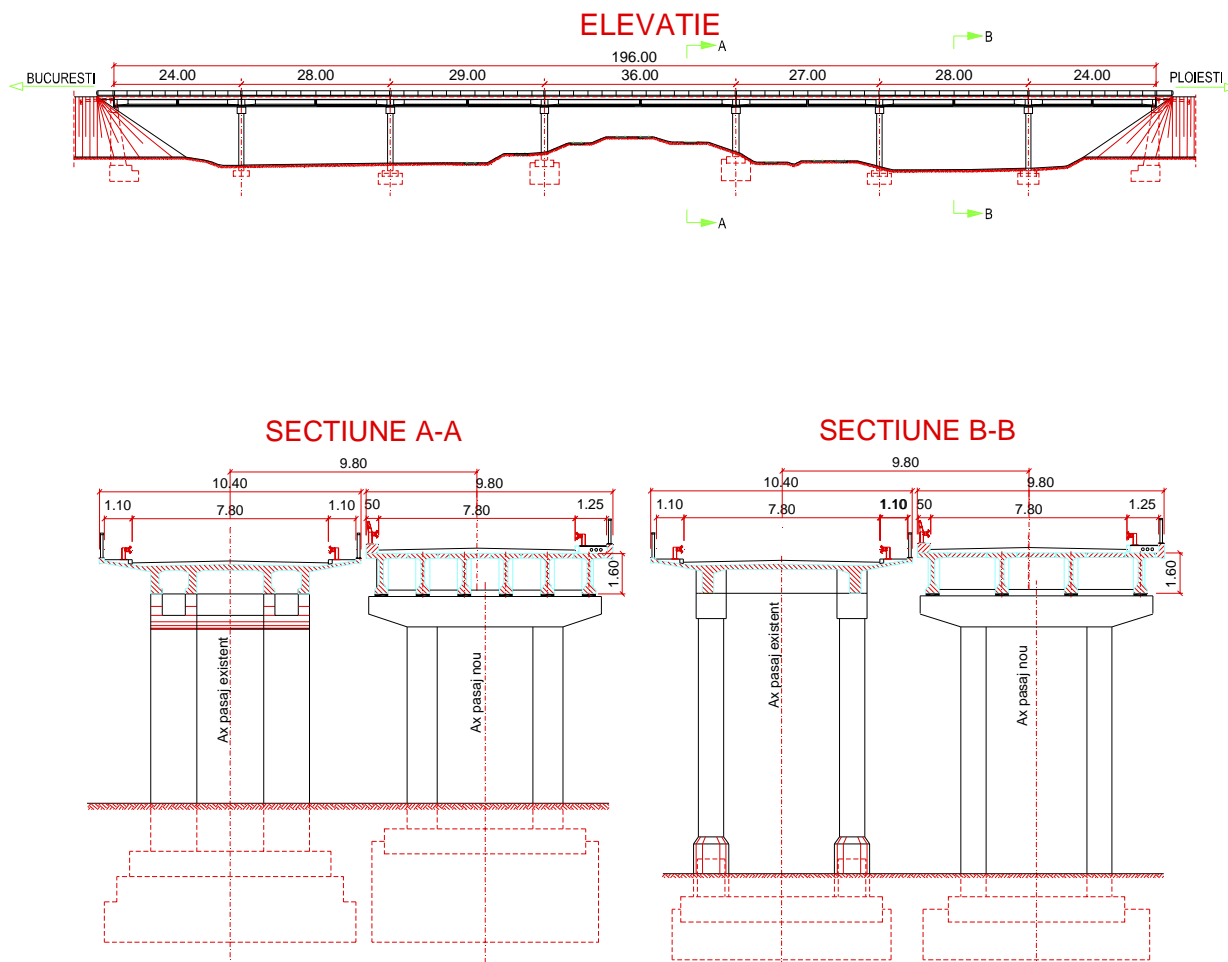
Pasaj Brazi pe DN1 Km 55+720
